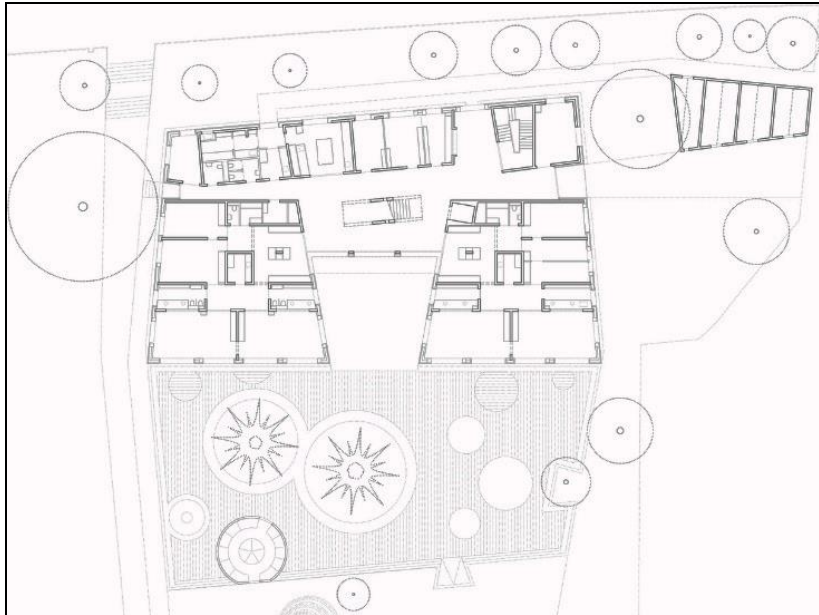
Salacuna en la Chapelle-les-Sciens - primera planta
